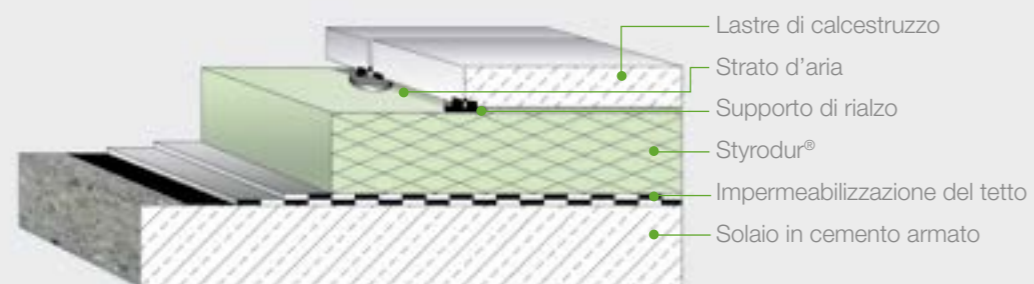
Tetto a parcheggio con lastre di calcestruzzo di piccolo formato, rialzate.
